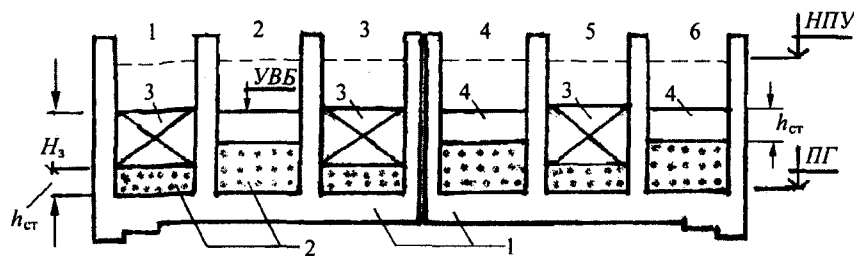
Двух ступенчатая схема бетонирования (закрытия) гребенки плотины: 1 – гребенка плотины, 2 – бетон, укладываемый при закрытии гребенки, 3 – затворы, 4 – свободные для пропуска воды пролеты
